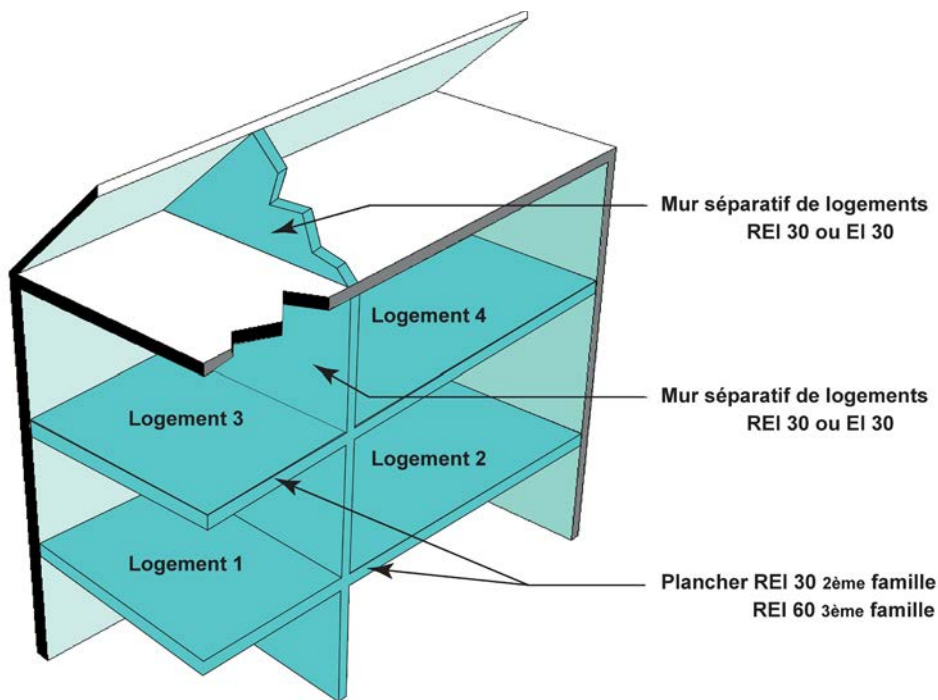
Exemple - plafond du dernier niveau avec séparation (2ème et 3ème famille)
